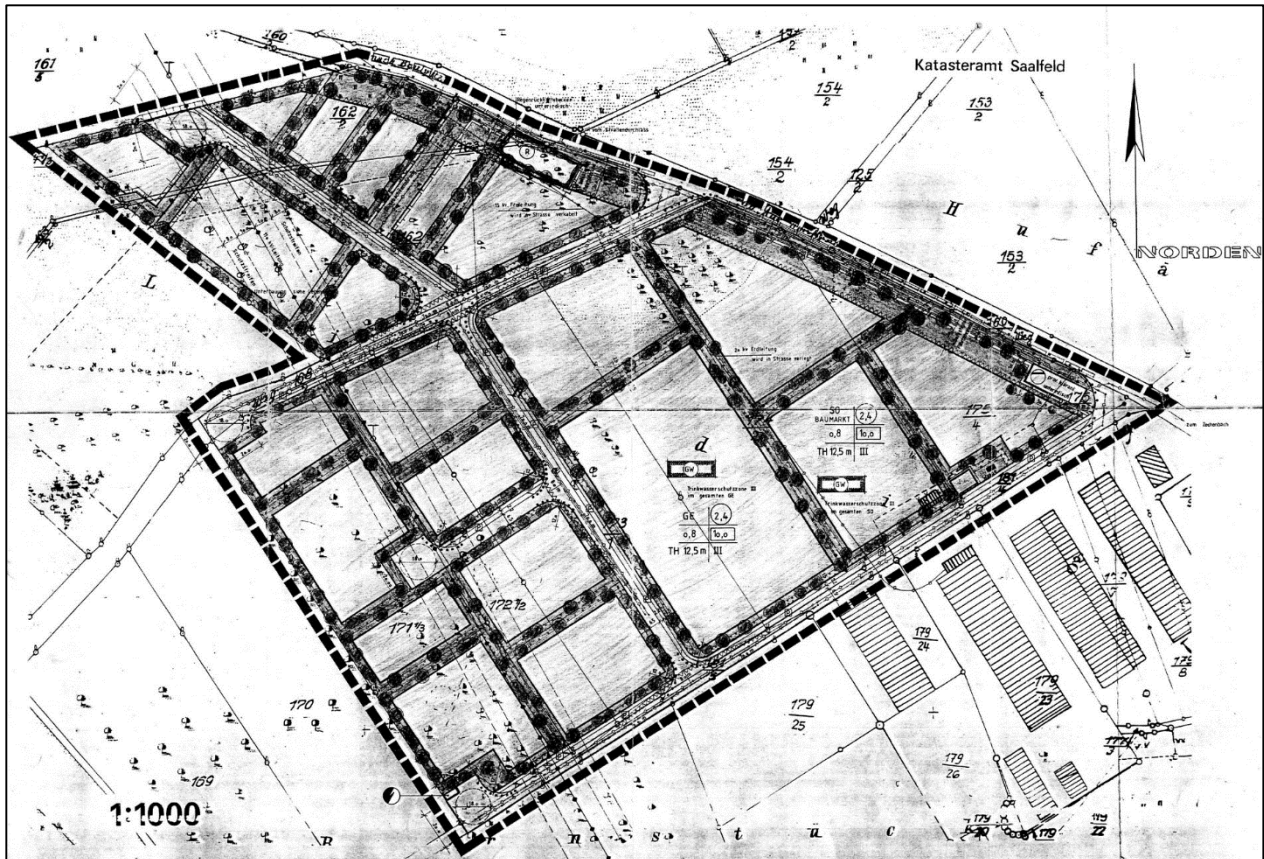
Bebauungsplan Gewerbegebiet Beulwitz (1992)
